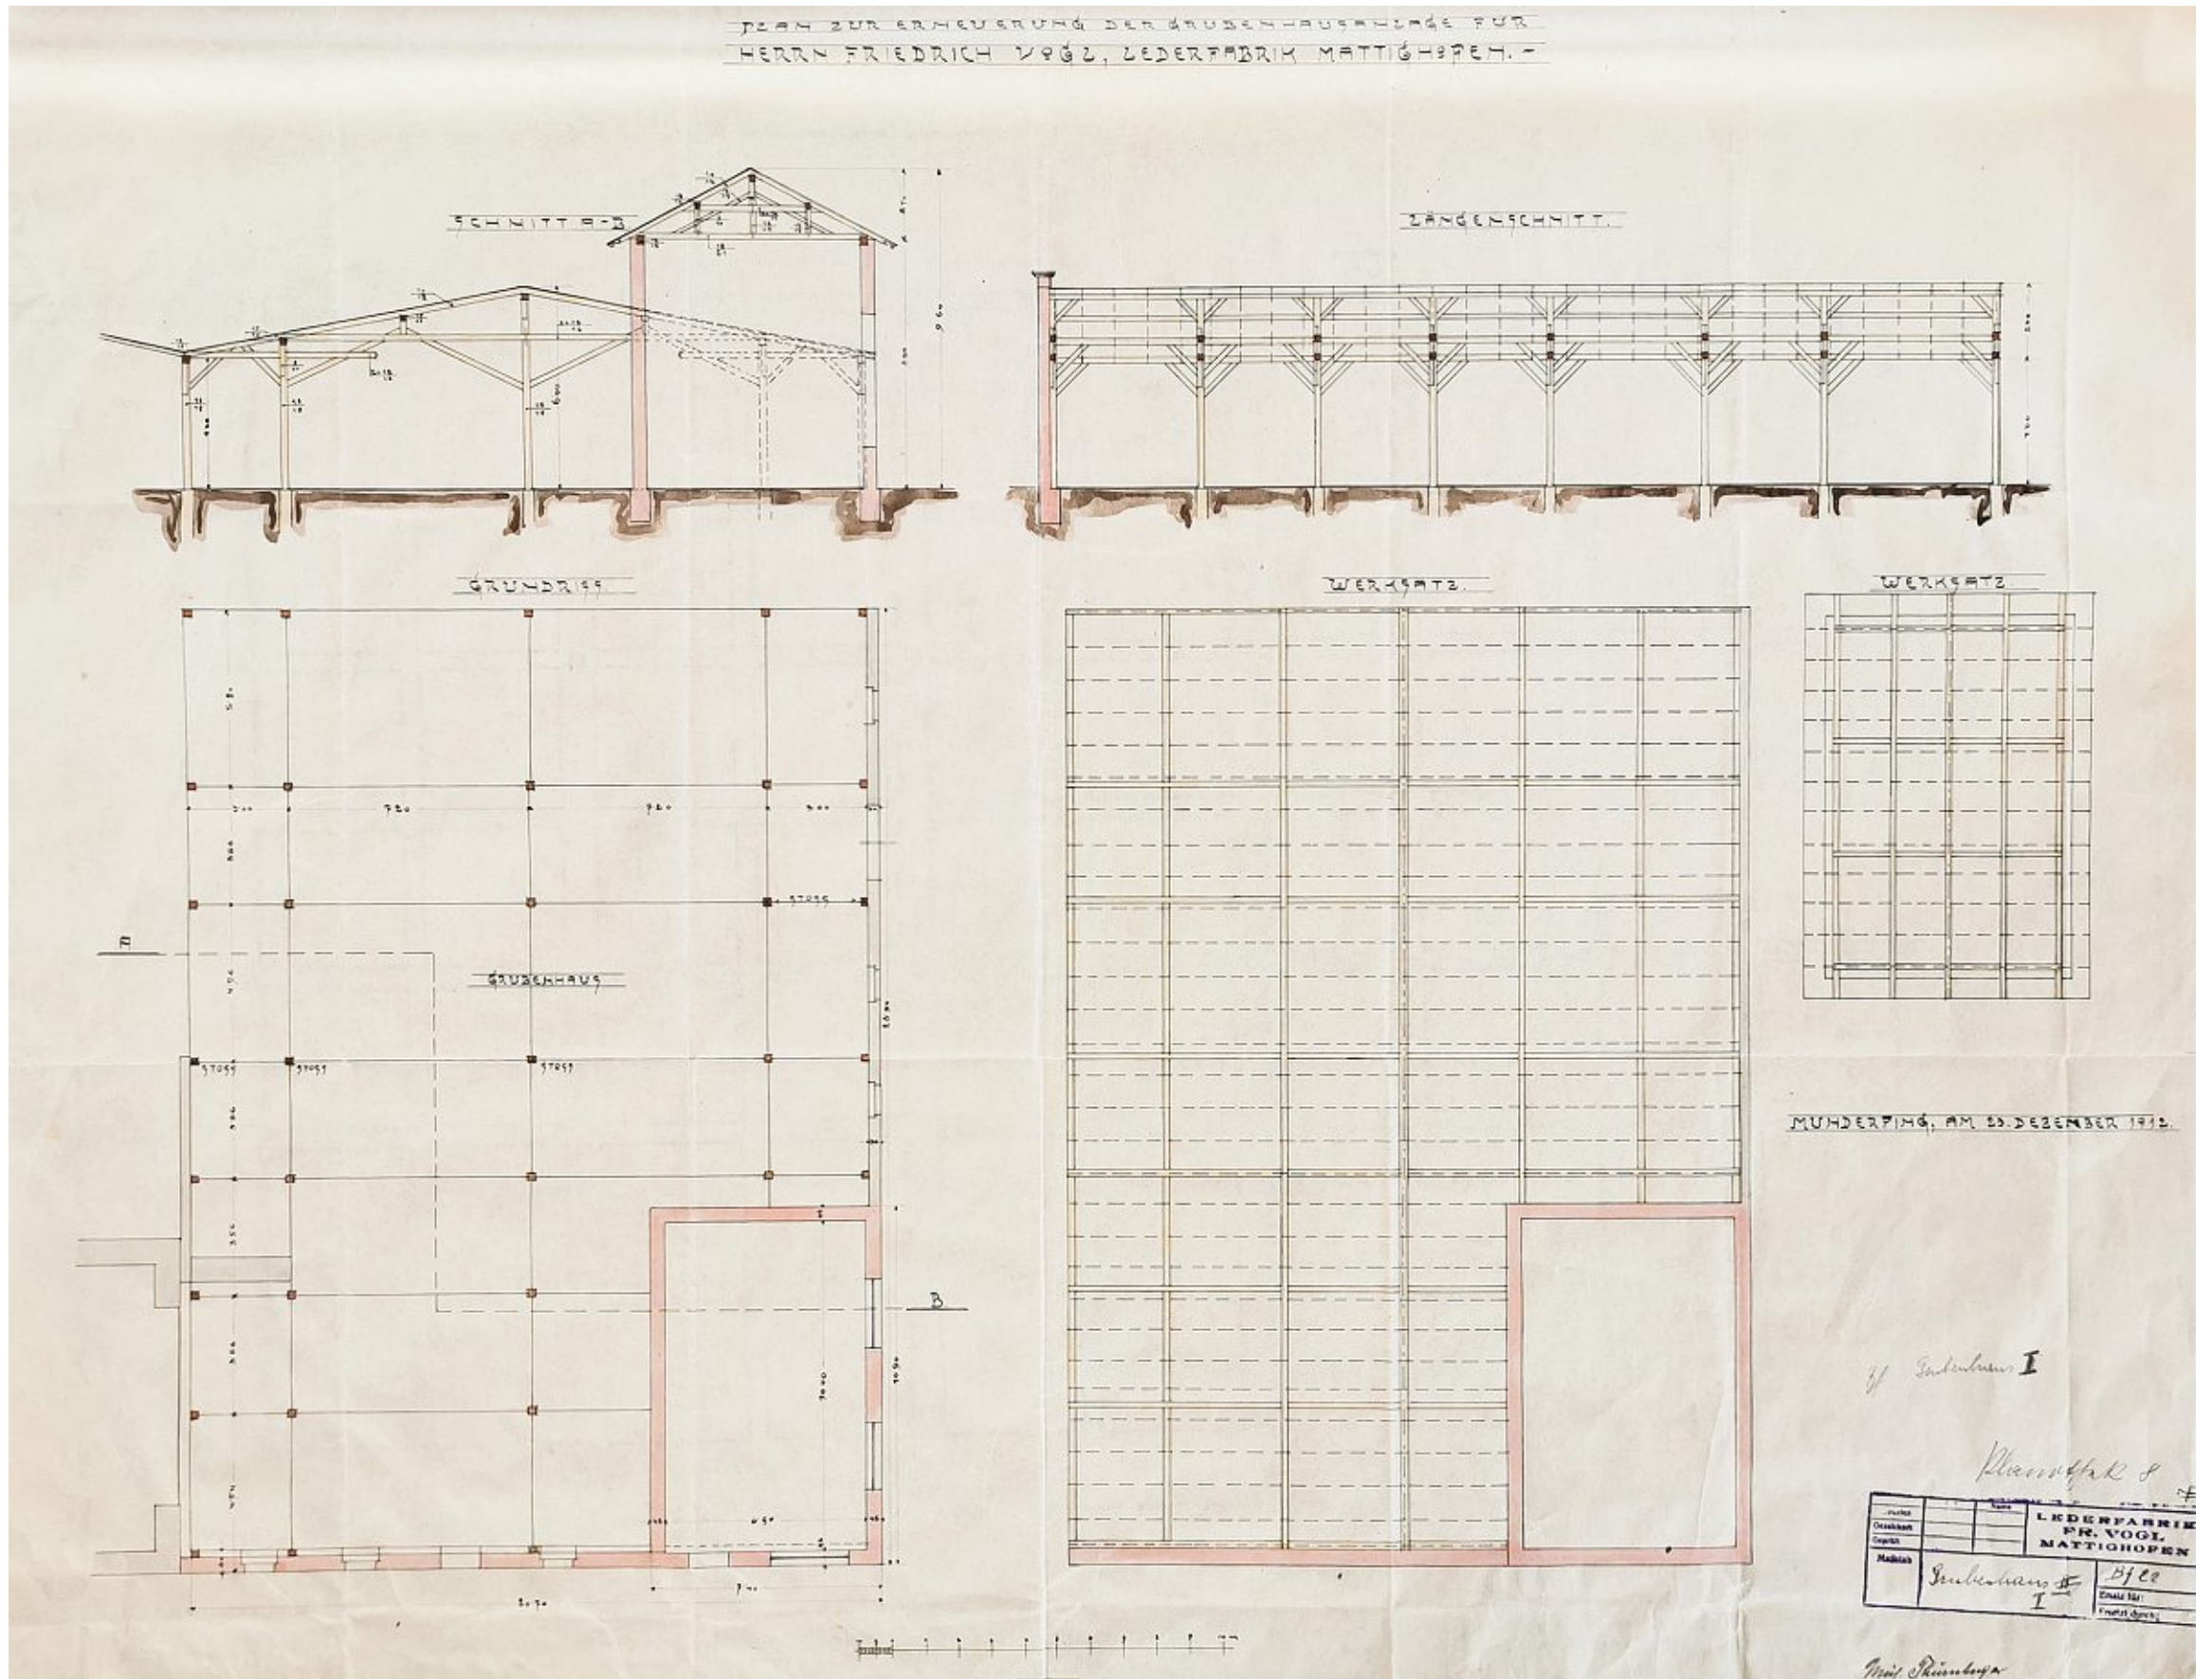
Dieser Originalplan zeigt die Dachkonstruktion des Grubenhauses I und stammt ebenfalls aus dem 19. Jahrhundert.
